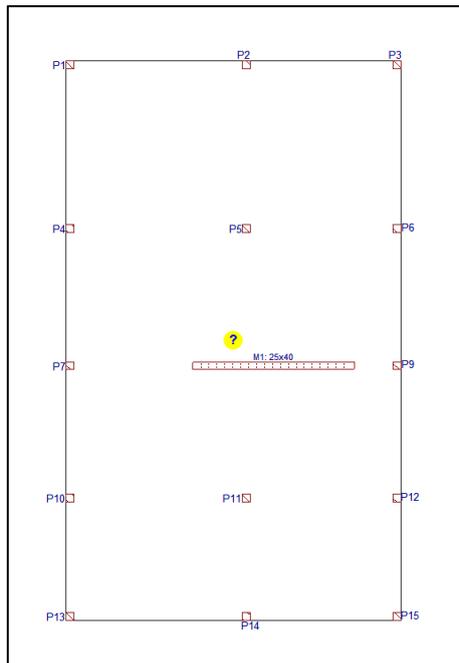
18. Recorte de pantalla, Planta de cimentación de Cypecad
